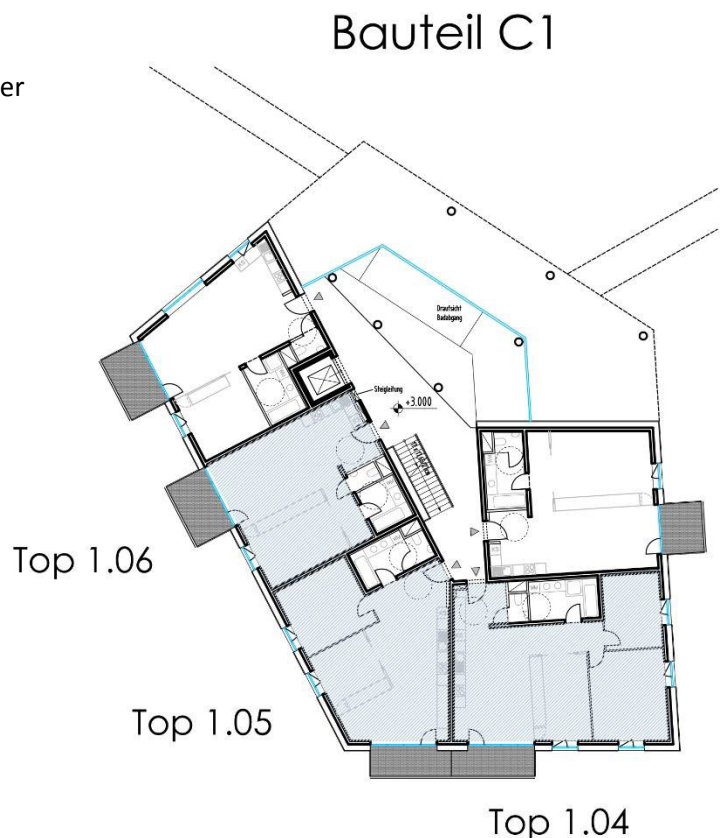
Sonnwendviertel, Bauteil C1, Grundriss
